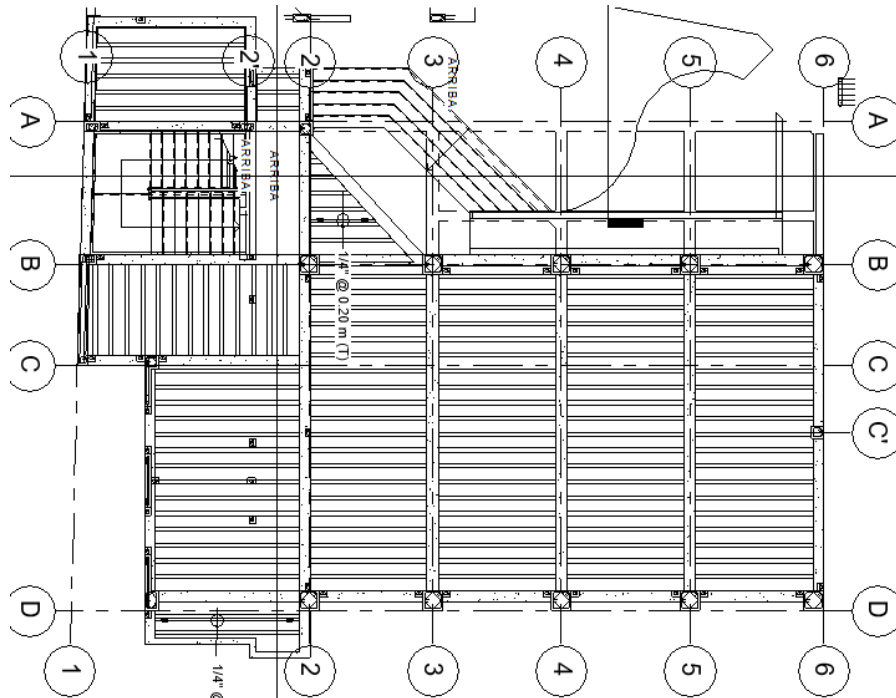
Elementos estructurales – Primer piso. Fuente: Autor
